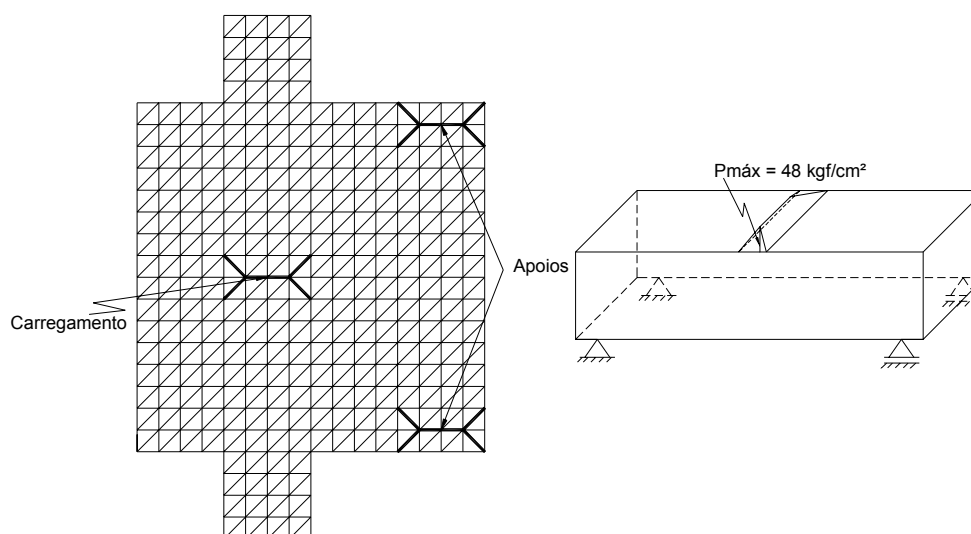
Discretização da viga de 80cm indicando carregamento e apoios para o elemento linear
